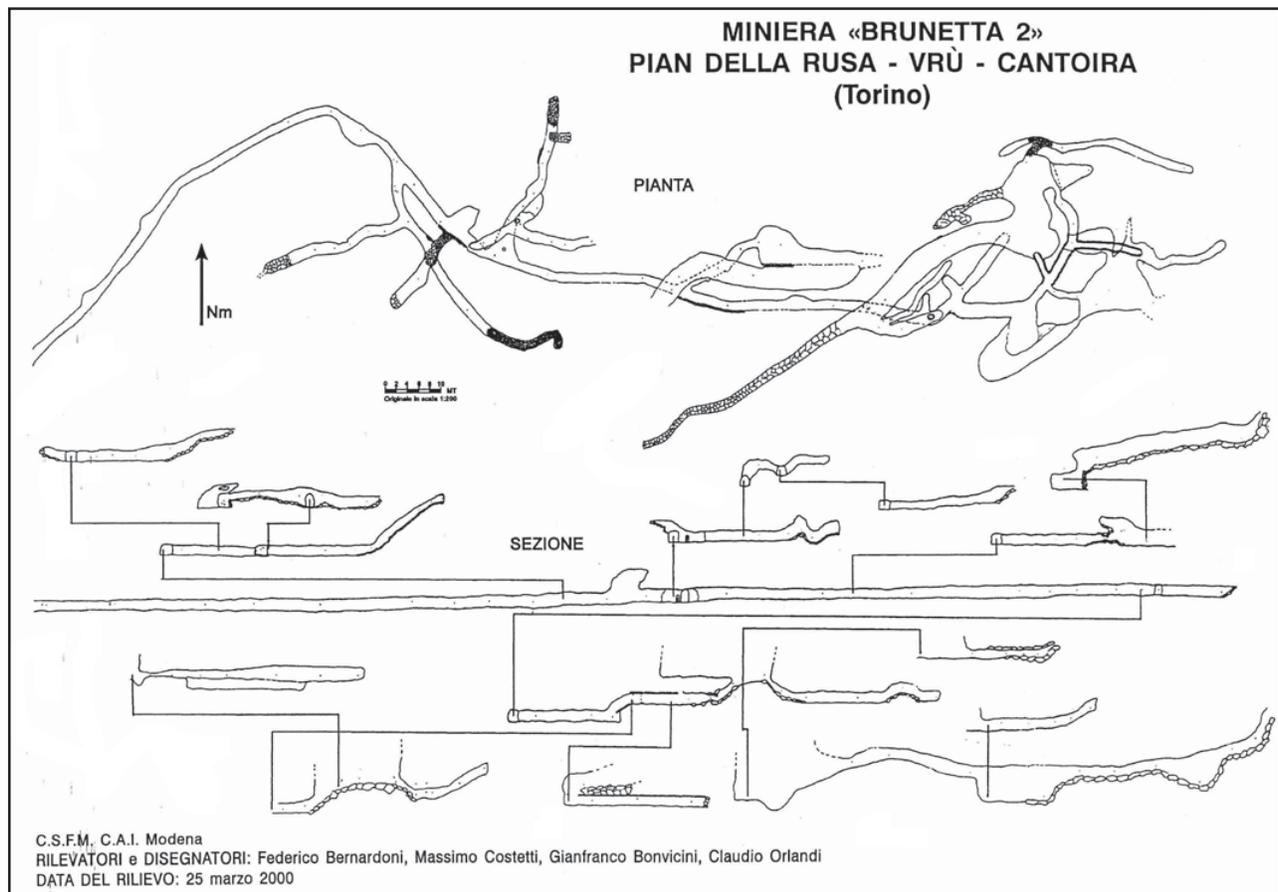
Planimetria e sezioni Miniera "Brunetta" 2.
